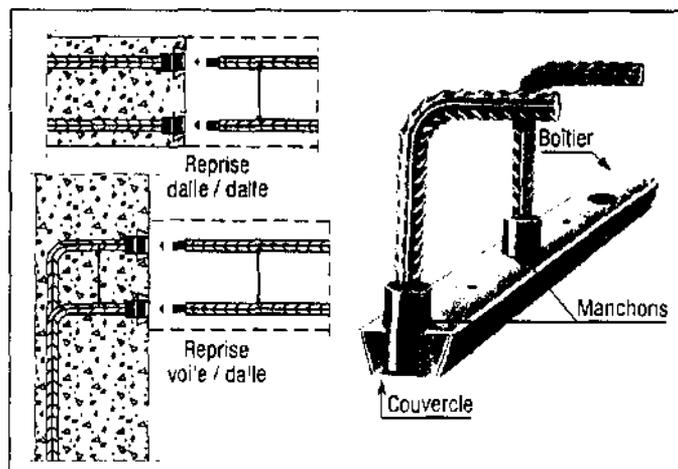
Raccordement d'armatures par vissage : système Coupler Box.
